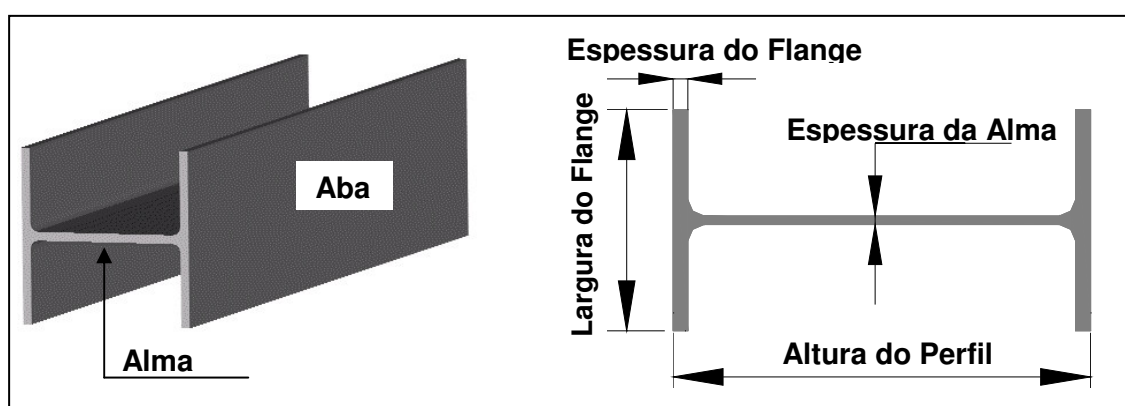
Principais dimensões de um perfil estrutural de abas paralelas.
